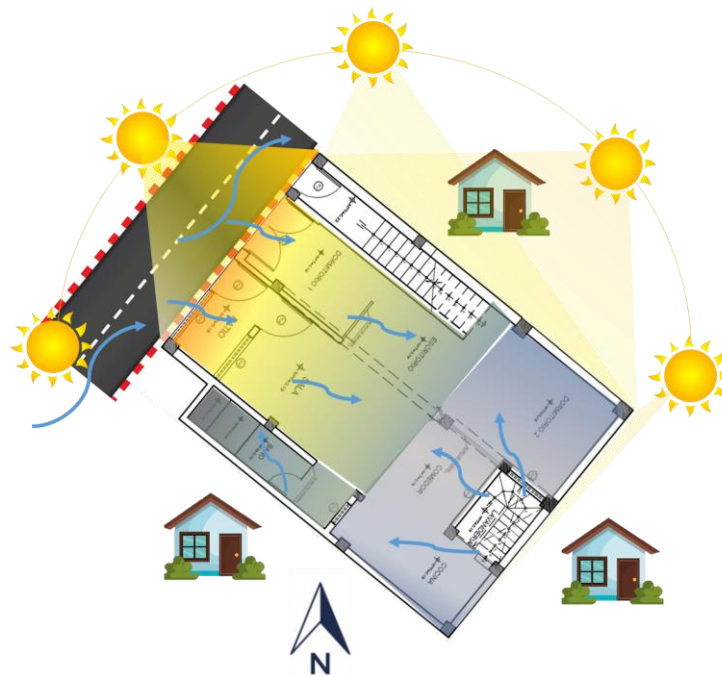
Plano de la vivienda FB – Nivel 1er piso
